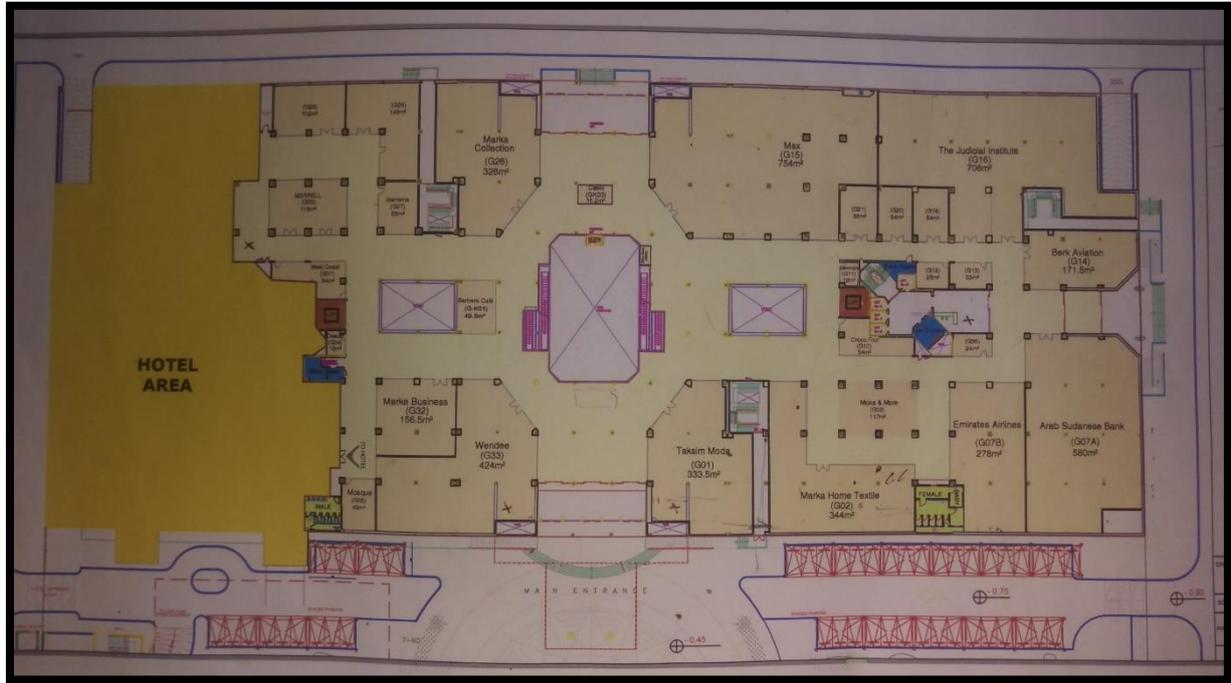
مسقط أفقي للطابق السفلي الاعلى
